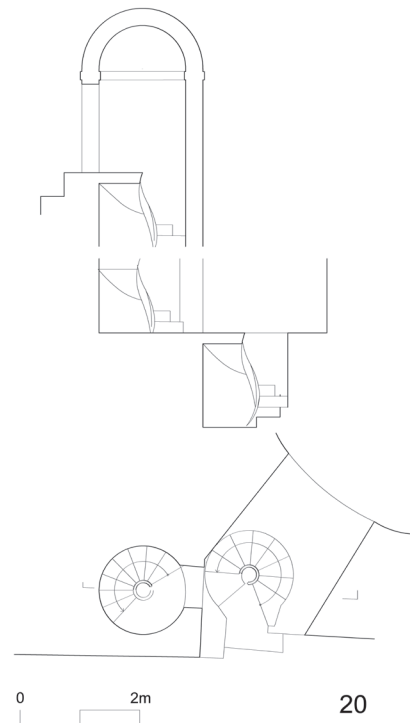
Secciones y plantas de la escalera de subida a cubierta de sala Capitular. (Dibujos del autor).
